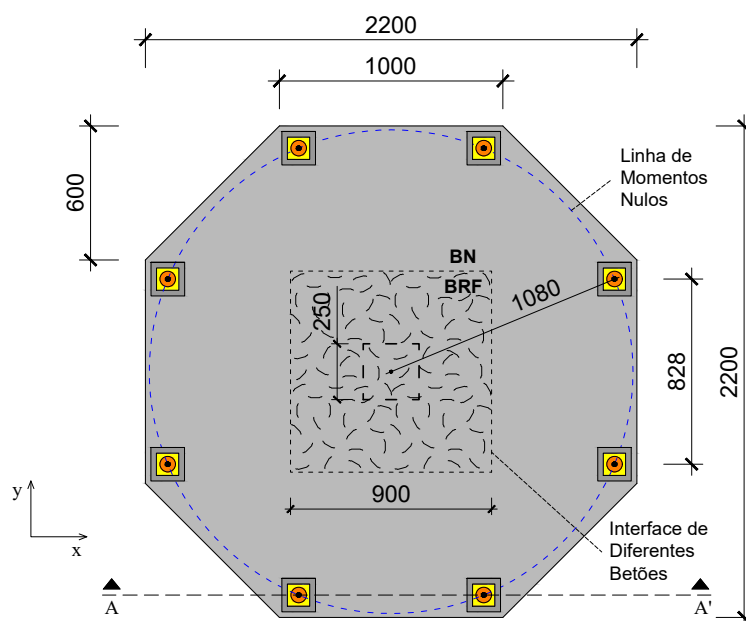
Geometria dos modelos em planta (desenho sem escala e dimensões em mm).
